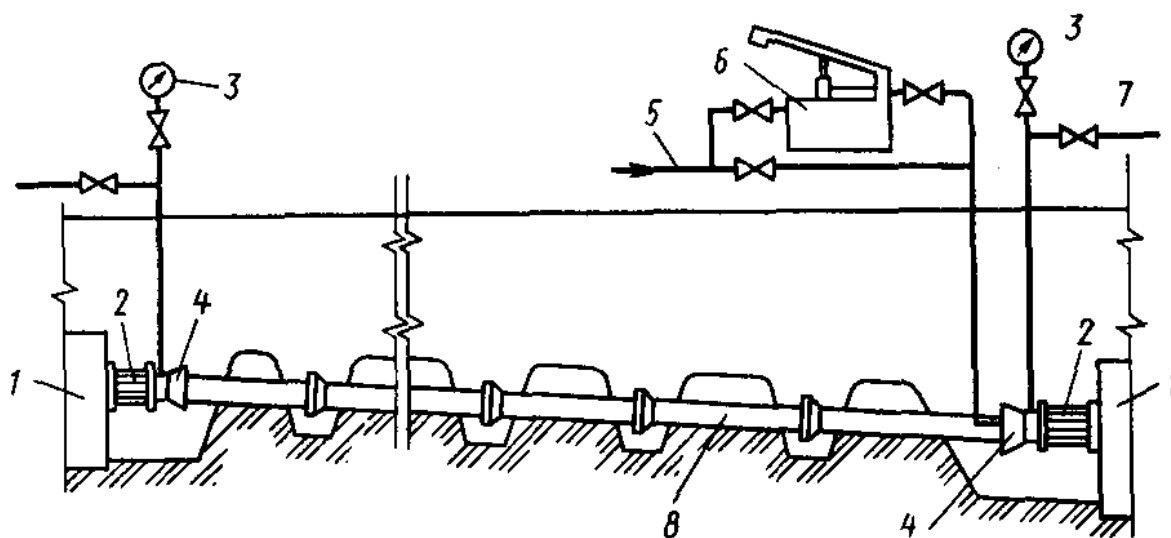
Гидравлическое испытание напорных водопроводных трубопроводов:
